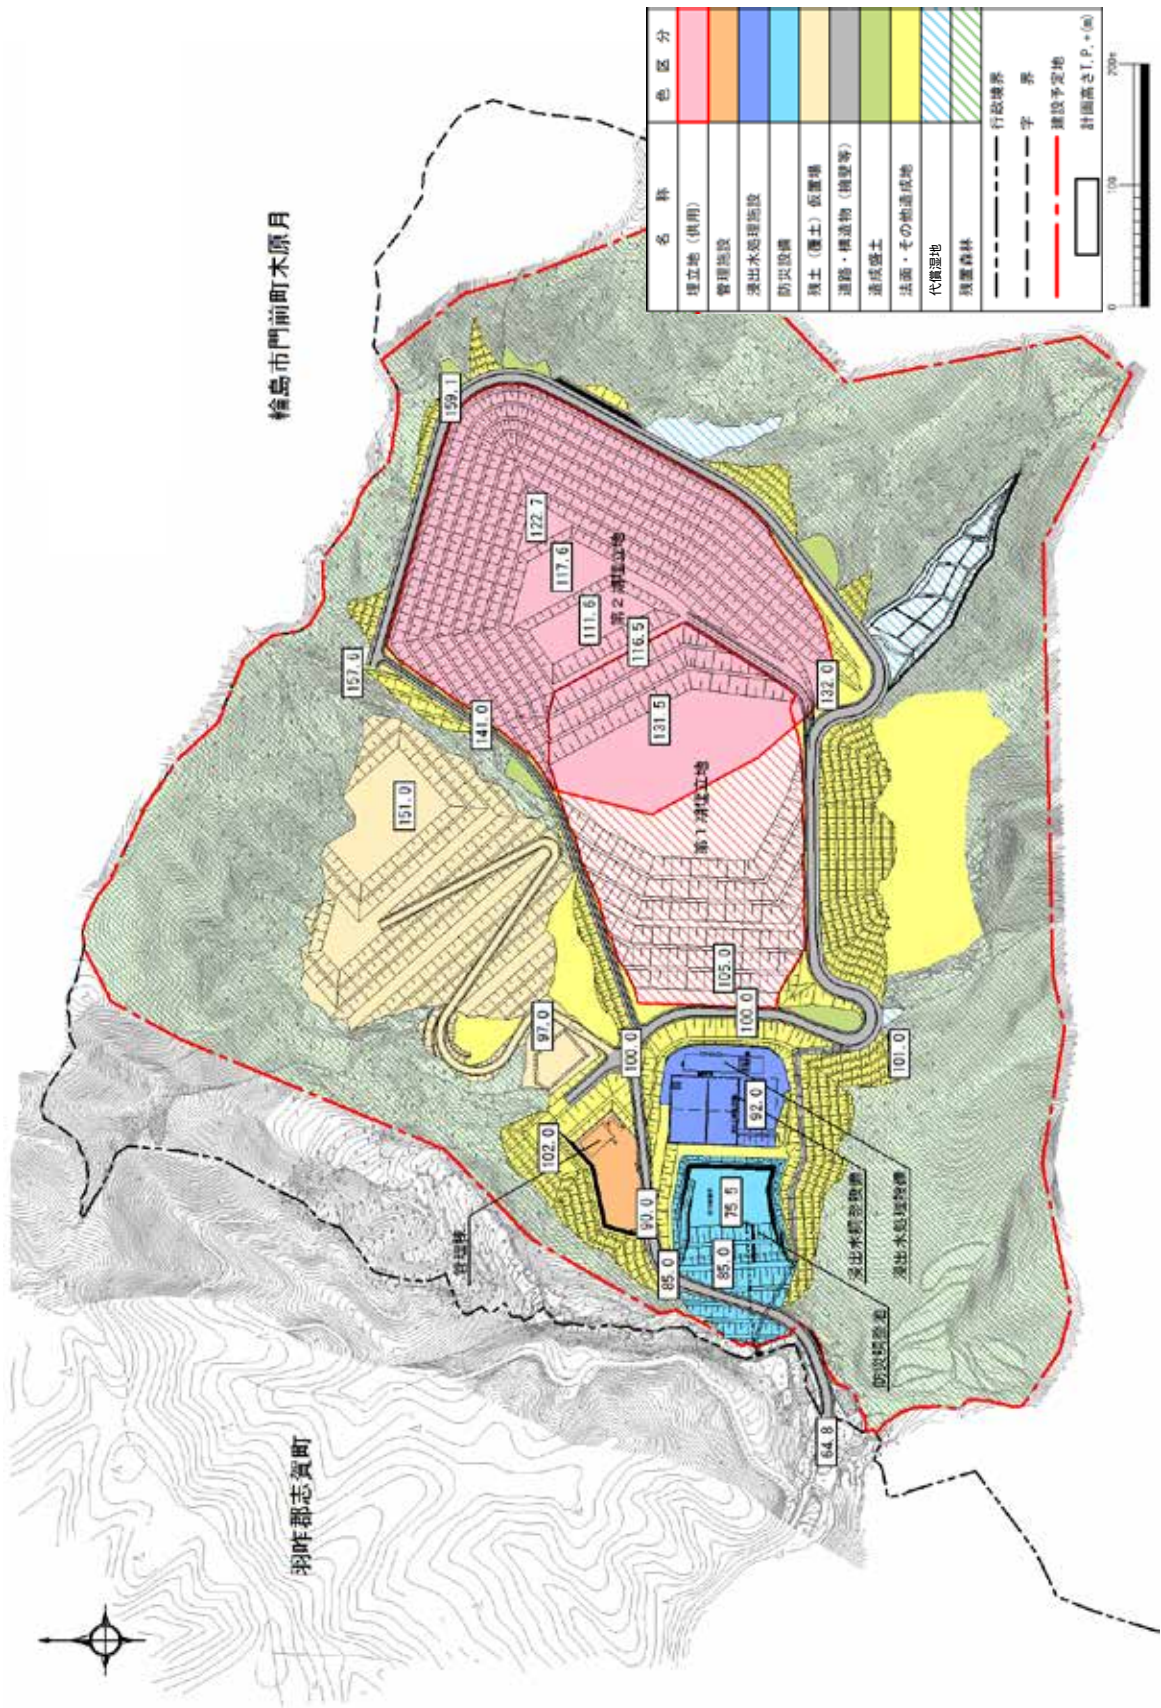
造成・施設配置計画平面図（第 2 期工事完了後）
